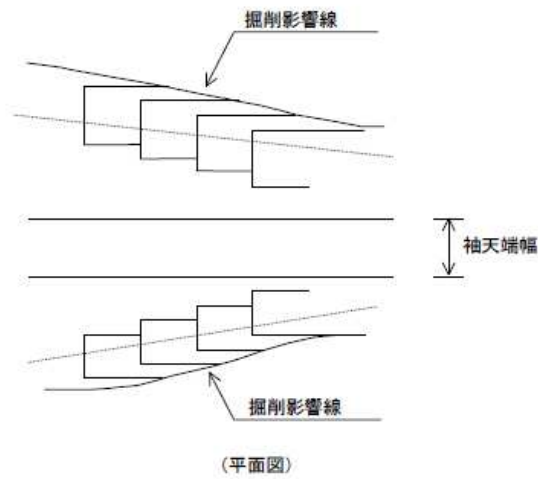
間詰めの設計(間詰コンクリートが階段状の場合)
